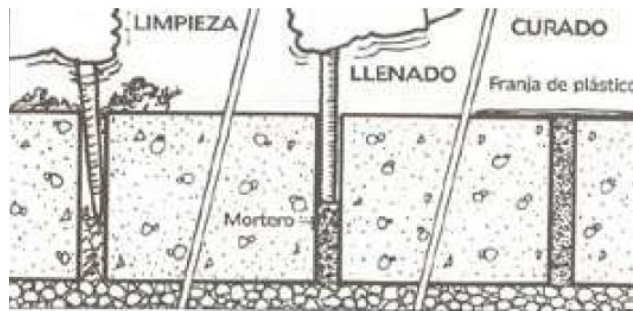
Limpieza y llenado de juntas con mortero en las losas de hormigón
